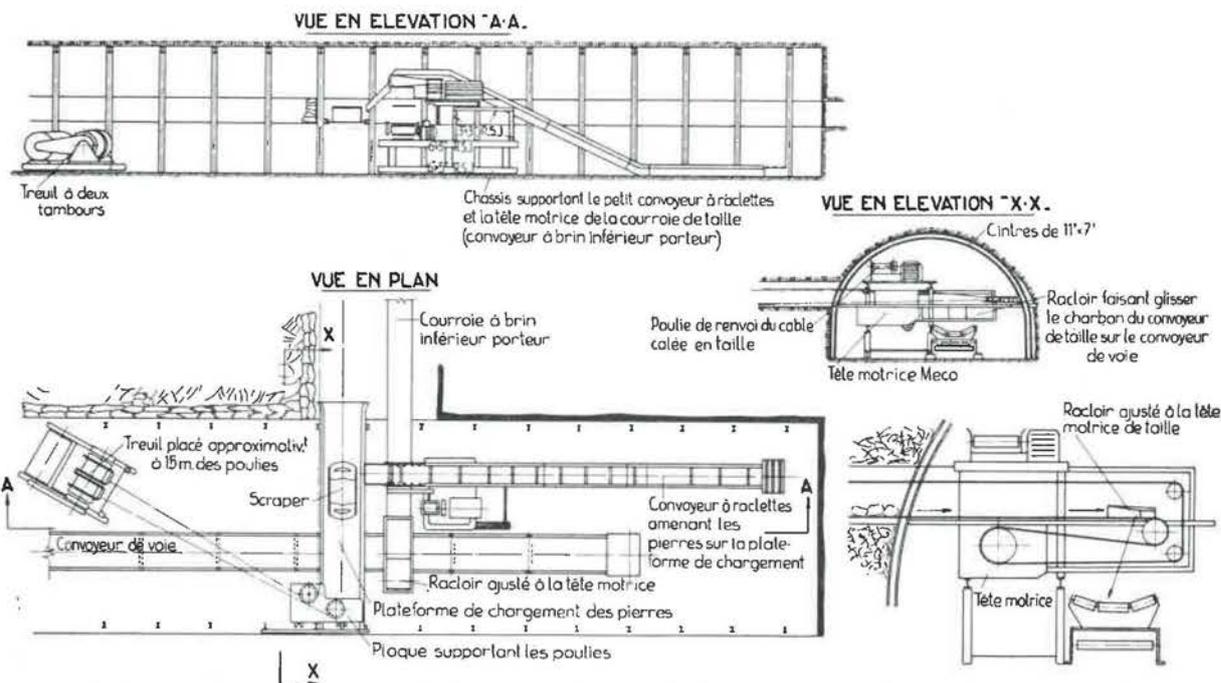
Remblayage par scraper des pierres du bossement d'une voie de base avec coupage du mur. On remarque la disposition des installations de transport et de l'estacade pour ramener les pierres en taille.
